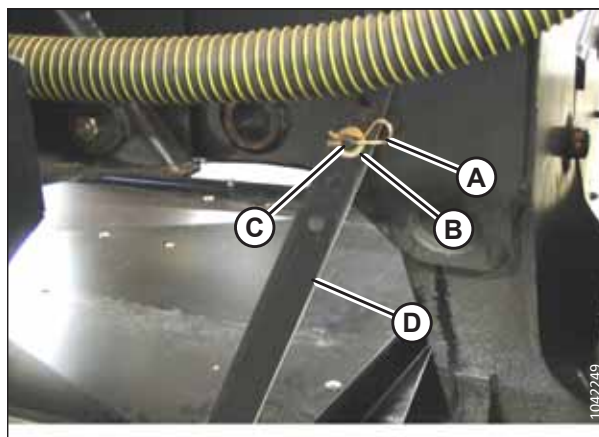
Резиновая стяжка для крепления формовочного щитка к лапе косилки
